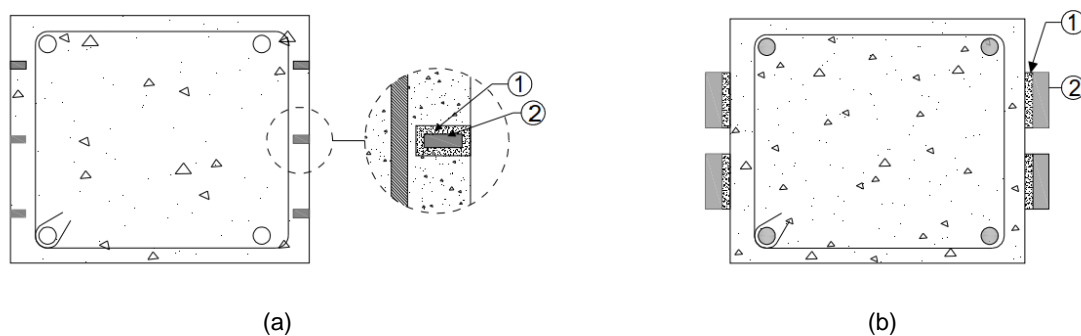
Reforço de pilares à flexão por colagem de armaduras de FRP com adesivo de ligação e por introdução de lâminas em ranhuras de 5x15 mm (a) e colagem de lâminas nas faces do pilar (b) – adaptado de (Sousa, 2008)
